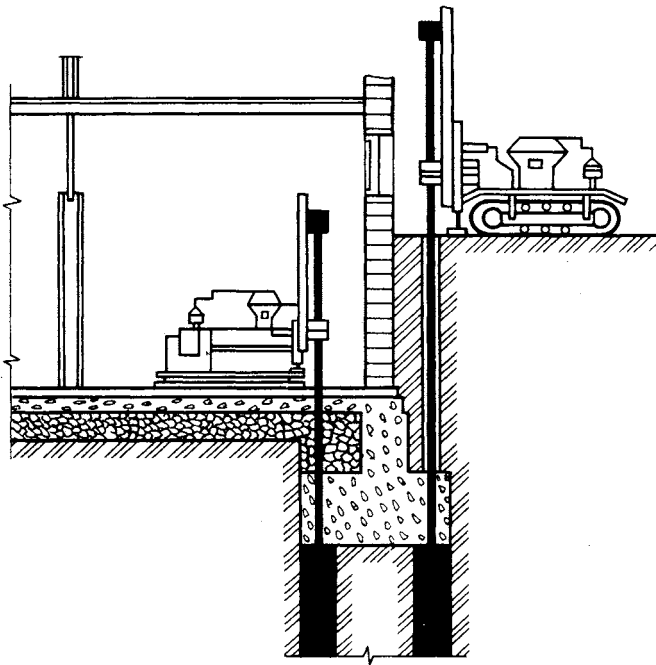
Подведение свайных фундаментов под реконструируемое здание
